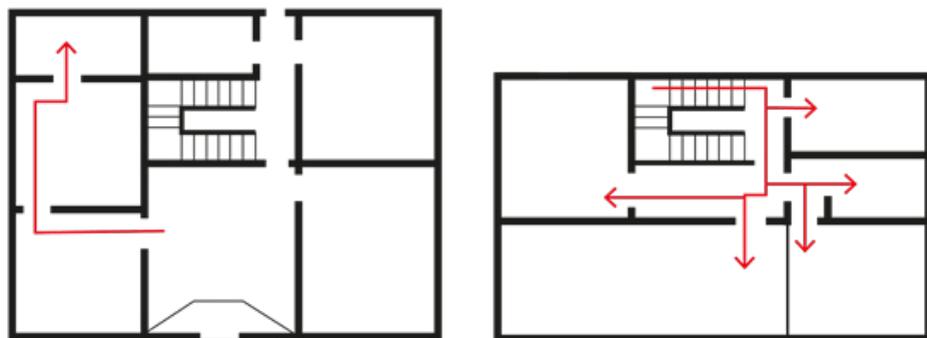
Esquema das plantas do térreo e do primeiro pavimento com a rota da exposição. Fonte: Autor, 2021.
